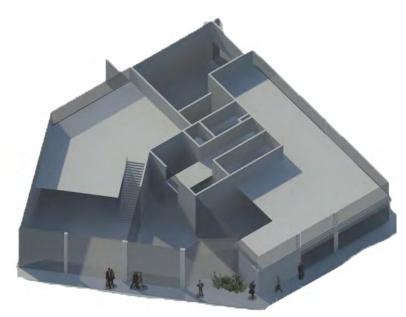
Vista de la distribución espacial Planta baja y mezzanine
